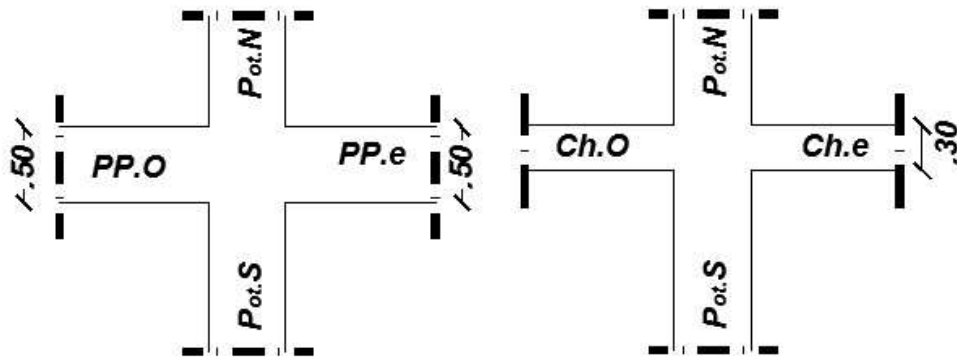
Sens xx// poutres et sens yy//chainages
